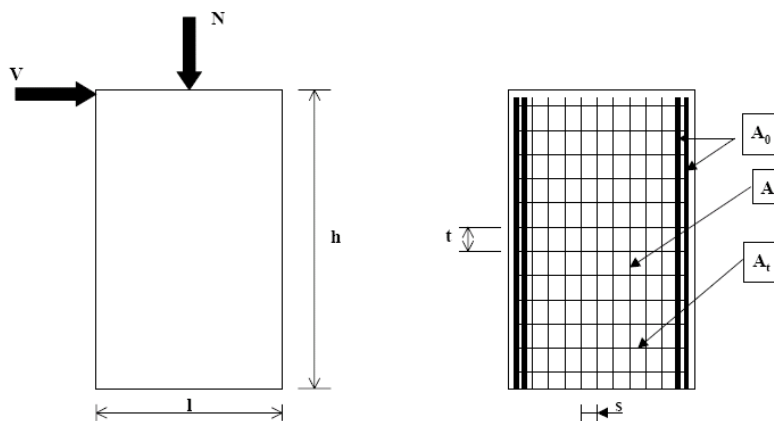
Schéma d'un voile plein et son disposition du ferrailage.
